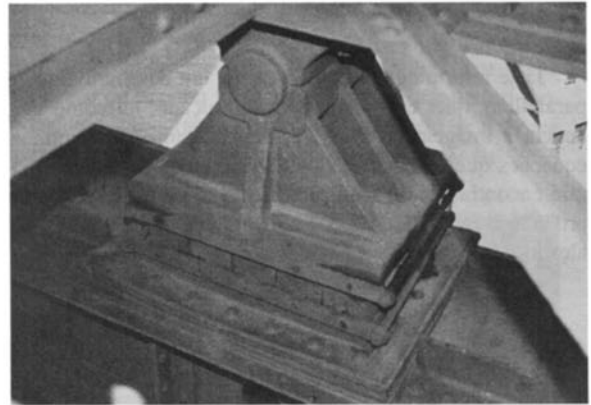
Apoio entre o tabuleiro superior e um pilar metálico
